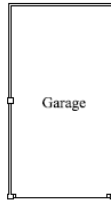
Planimetria garage - stato di fatto (fuori scala) – (Allegato L.03.03)
